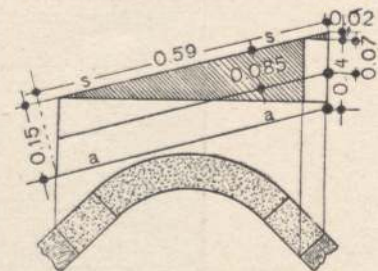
Ermittlung der genauen Holzlänge- und Holzdicke (Holzhöhe) zu dem Übergangskrümmling.
